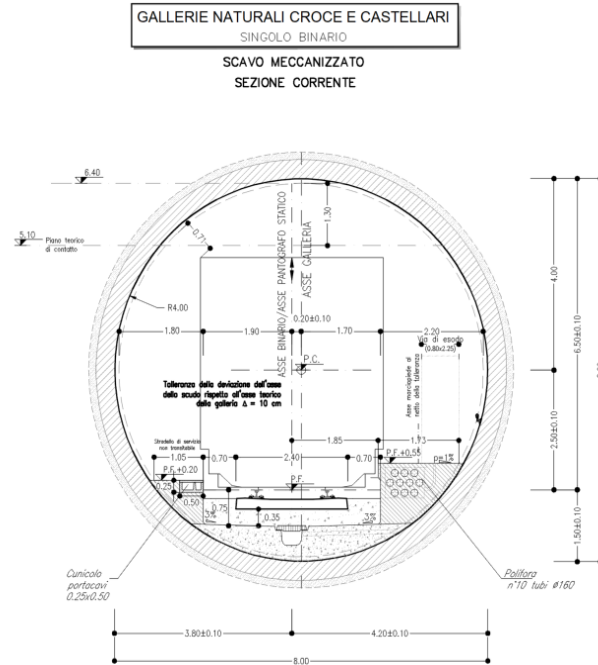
Sezione tipo di intradosso galleria Castellari e Croce
